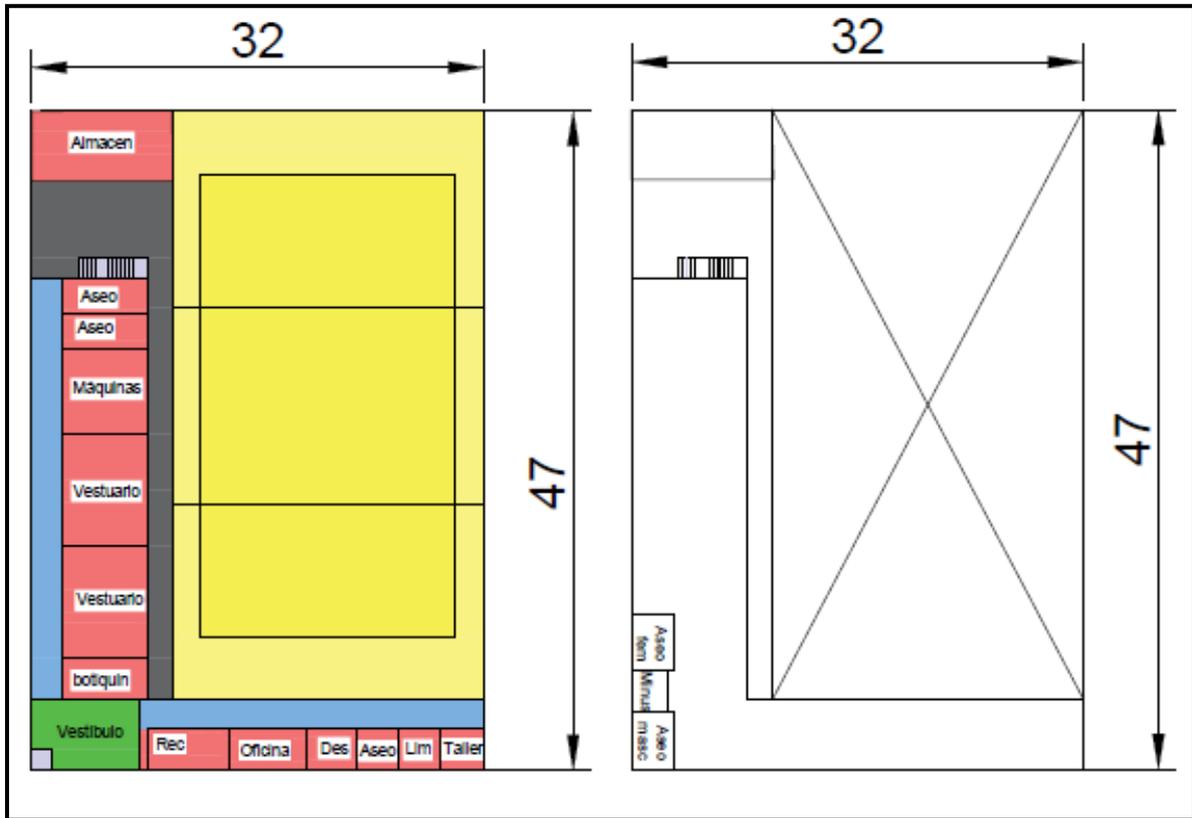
Distribución de los espacios de la alternativa 2. Planta baja (izquierda) y Planta 1 (derecha). (Fuente: Elaboración propia).
